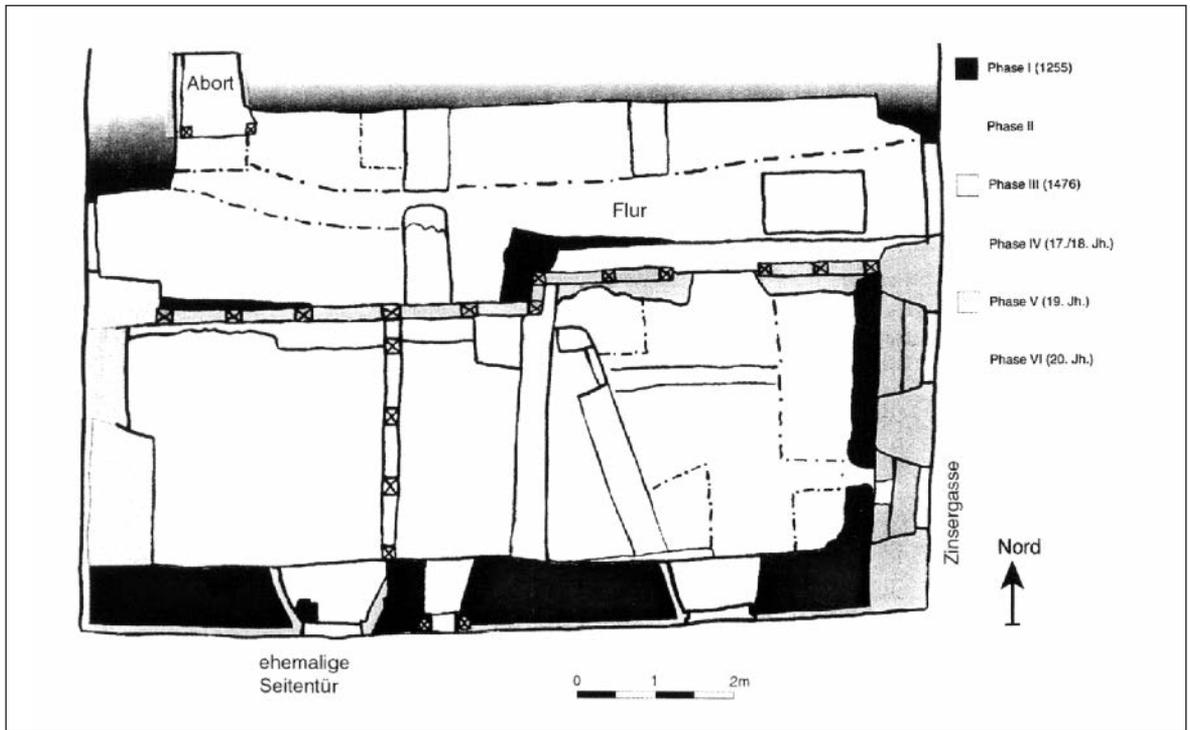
Villingen, Zinsergasse 12. Grundriss des Erdgeschosses mit baulichen Befunden und Phasenkennzeichnungen.
